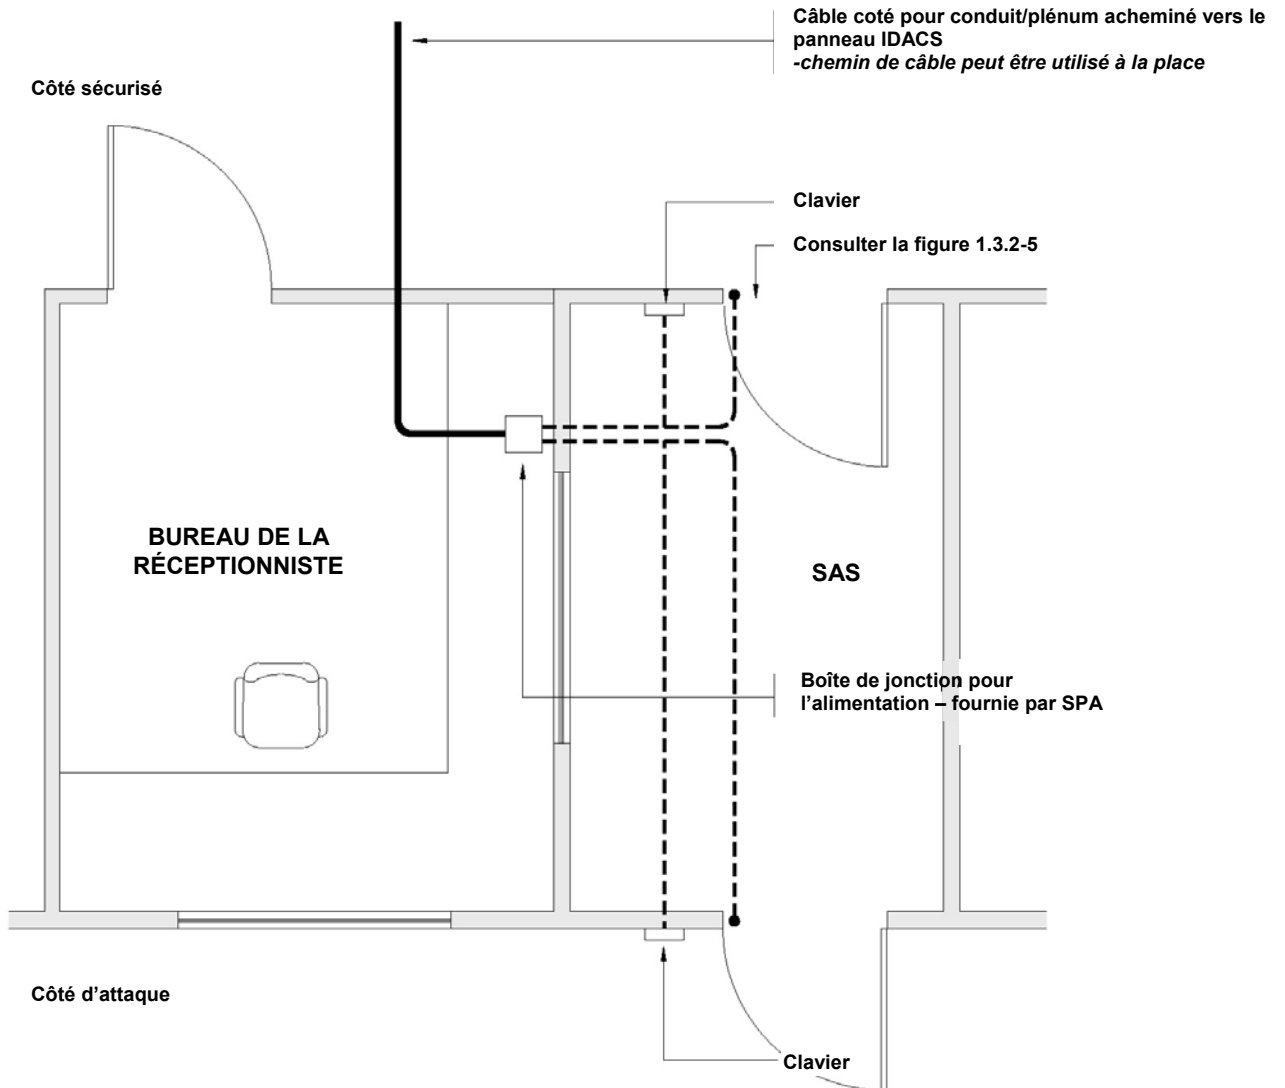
Plan d'aménagement des conduits du sas.
